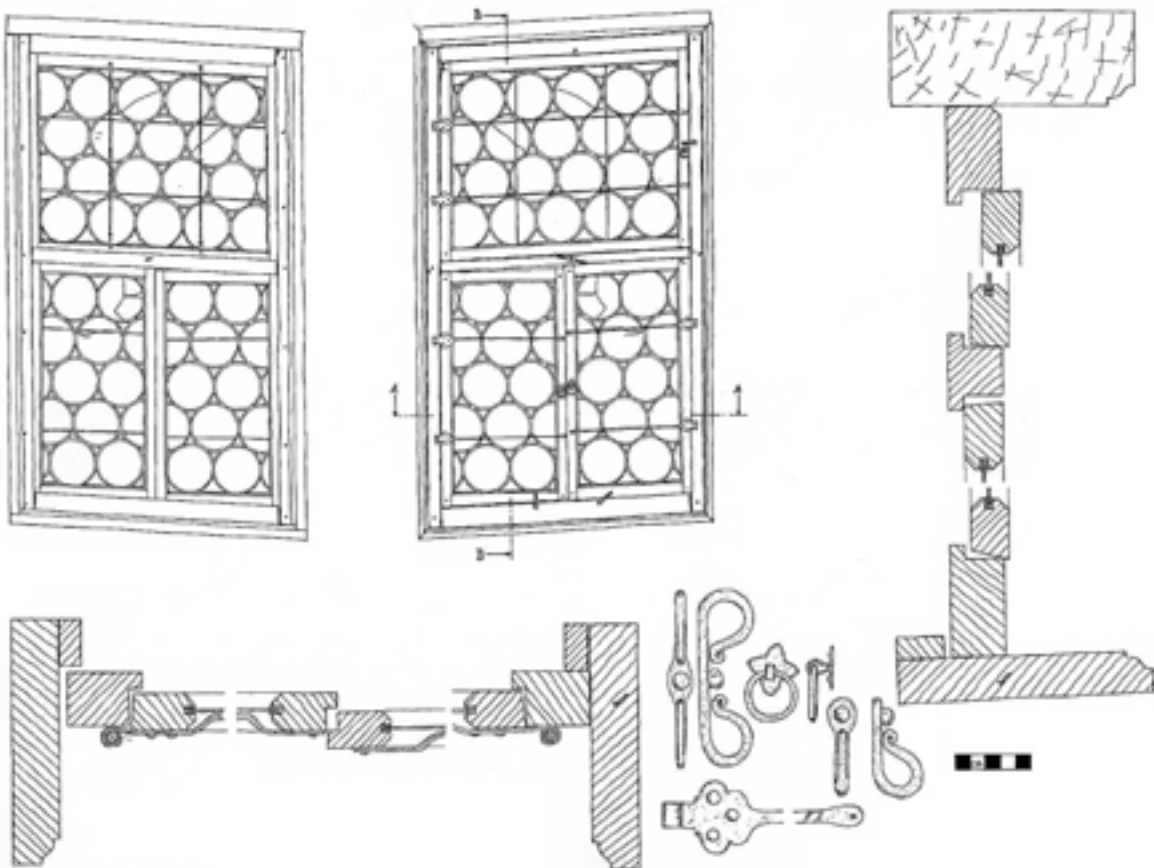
Nördlingen, Polizeigasse 20, „Mötzelsches Haus“, erbaut 1634: Ein bauzeitlicher Fensterbestand ist einschließlich der Verglasung vollständig erhalten.
